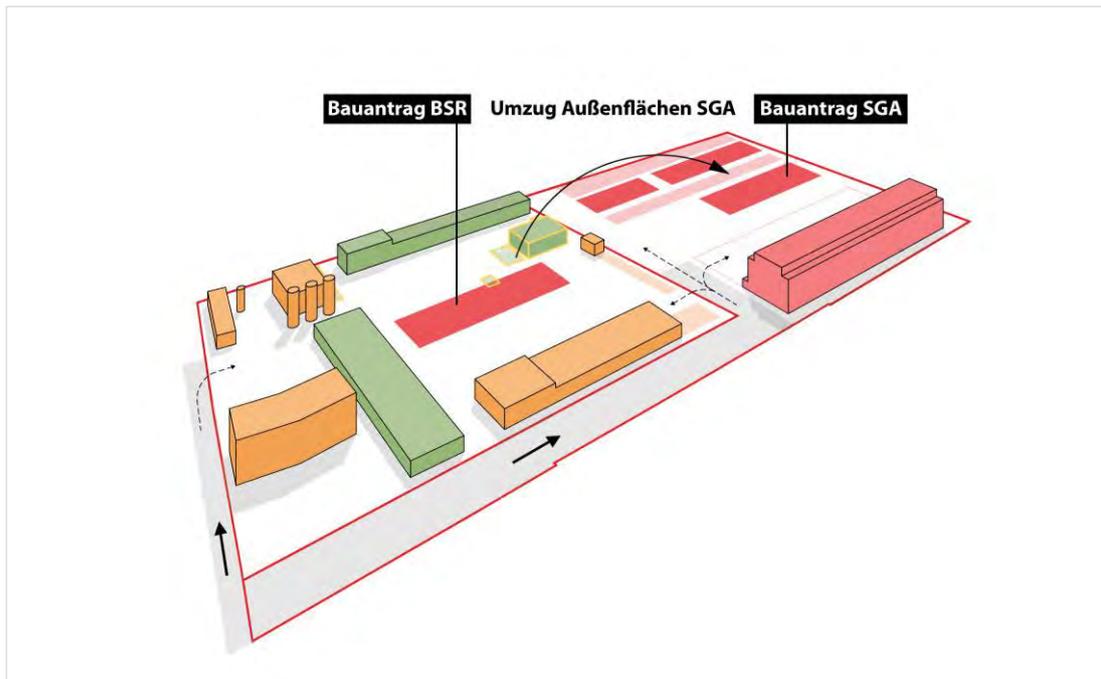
Bauantrag BSR/ SGA, Umzug Außenflächen SGA
